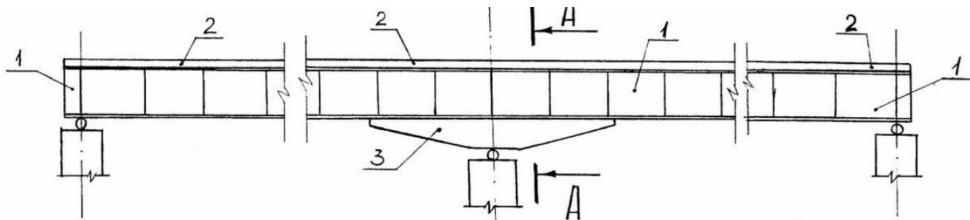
Сталезалізобетонна нерозрізна балка: 1 – сталеві балка; 2 – залізобетонна плита; 3 – залізобетонний вут нижче нижнього поясу балки над проміжною опорою, зв'язаний з сталеві балкою
